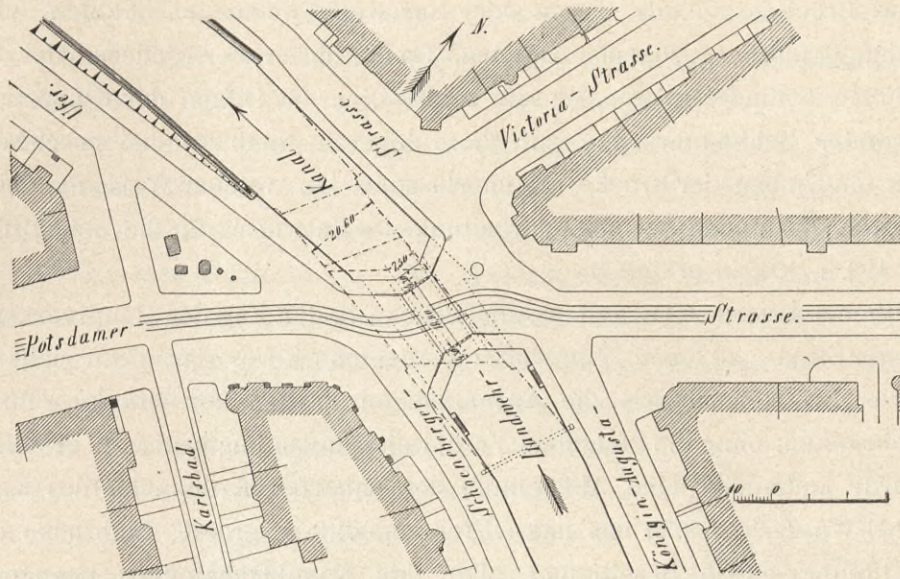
Lageplan der Potsdamer Brücke vor dem Umbau.
